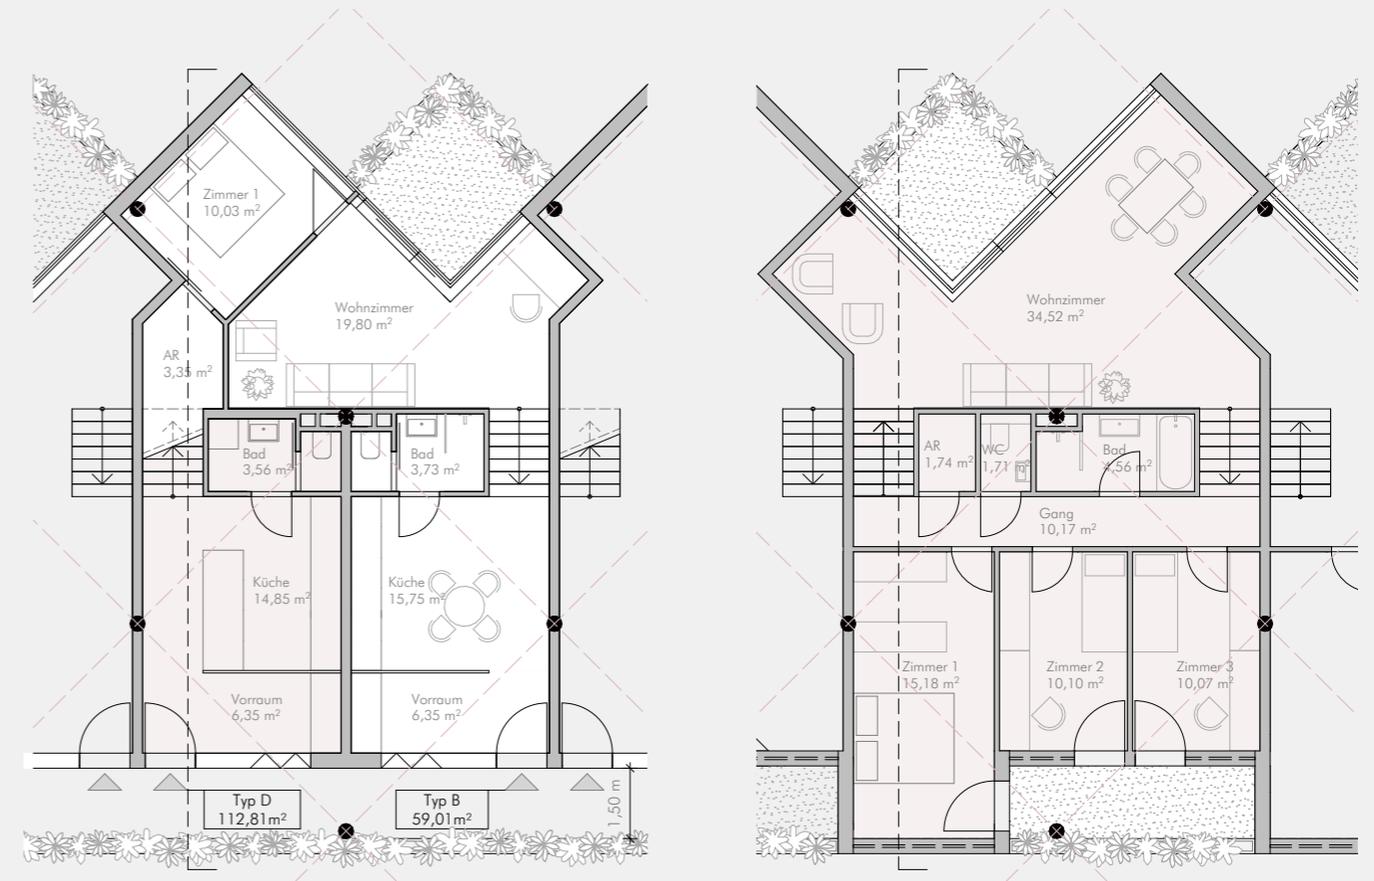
| Grundrisse der Split-Level Wohnungen im Maßstab 1:150
